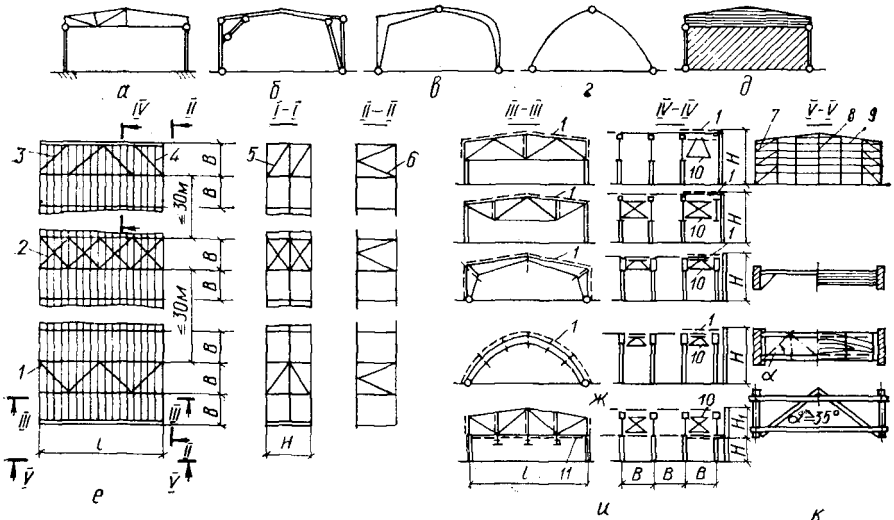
Схемы поперечных несущих конструкций зданий и связей в покрытиях и стенах:
